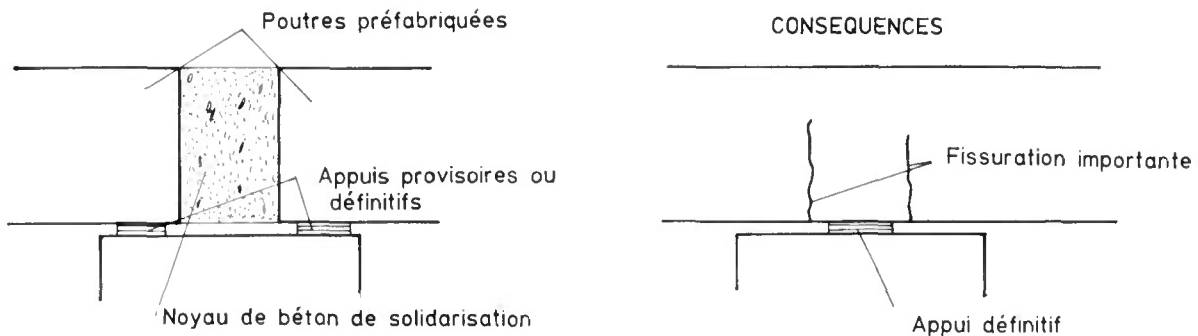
Fissuration sur appui d'ouvrages construits en travées indépendantes puis rendus continus.
